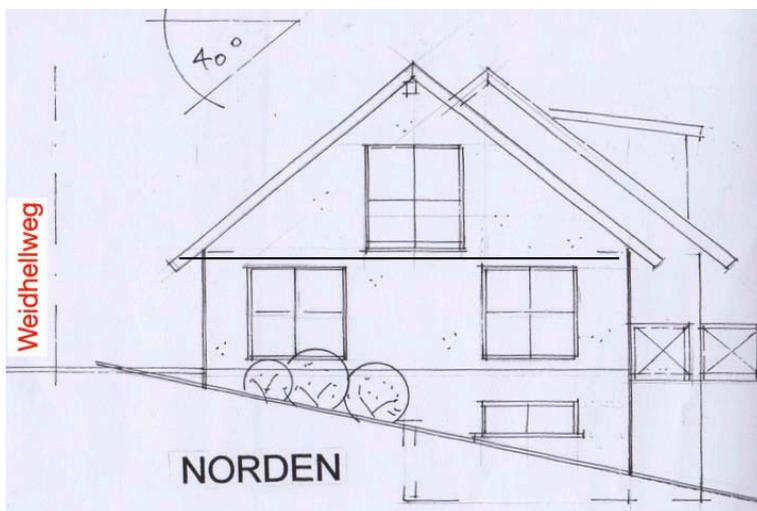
„Vorhaben“ (Entwurf Planungsbüro Ott, 27.04.23)
